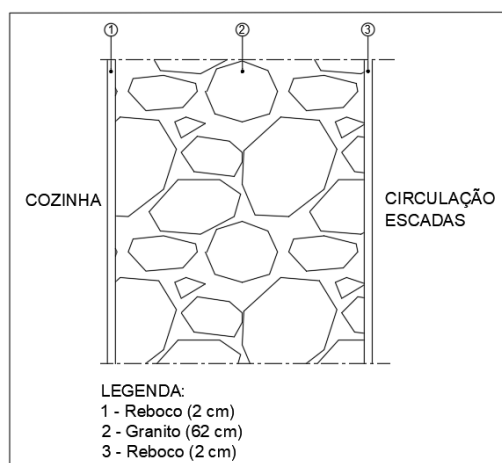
Pormenor construtivo da parede cozinha/ circulação de escadas
